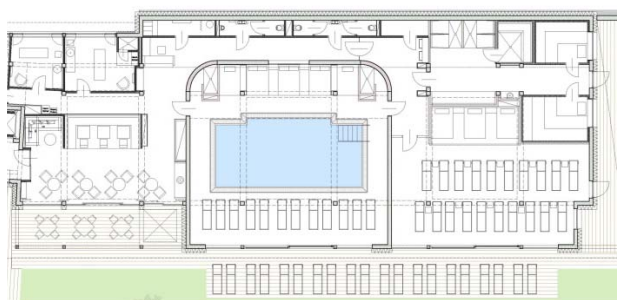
Grundriss Schwimmbad- und Wellnessbereich.
